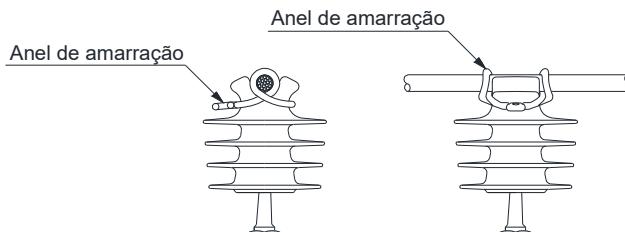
Amarrações e ligações – Amarração de topo do cabo protegido – Anel de amarração
